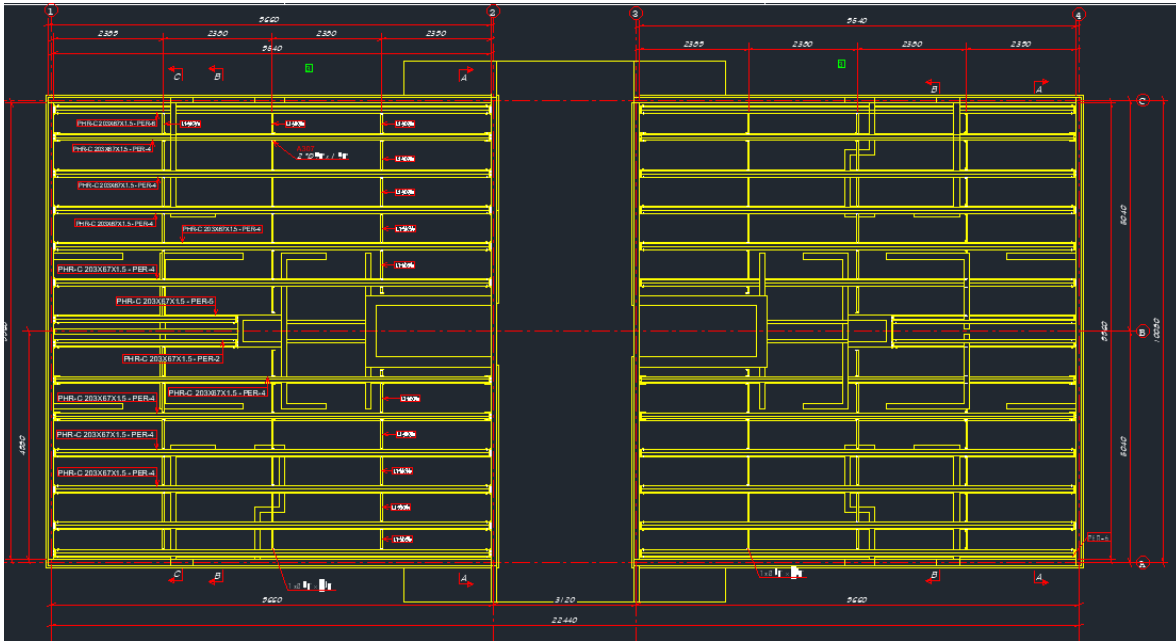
vista en planta del sistema estructural de cubierta Arrayanes de San Sebastián.
